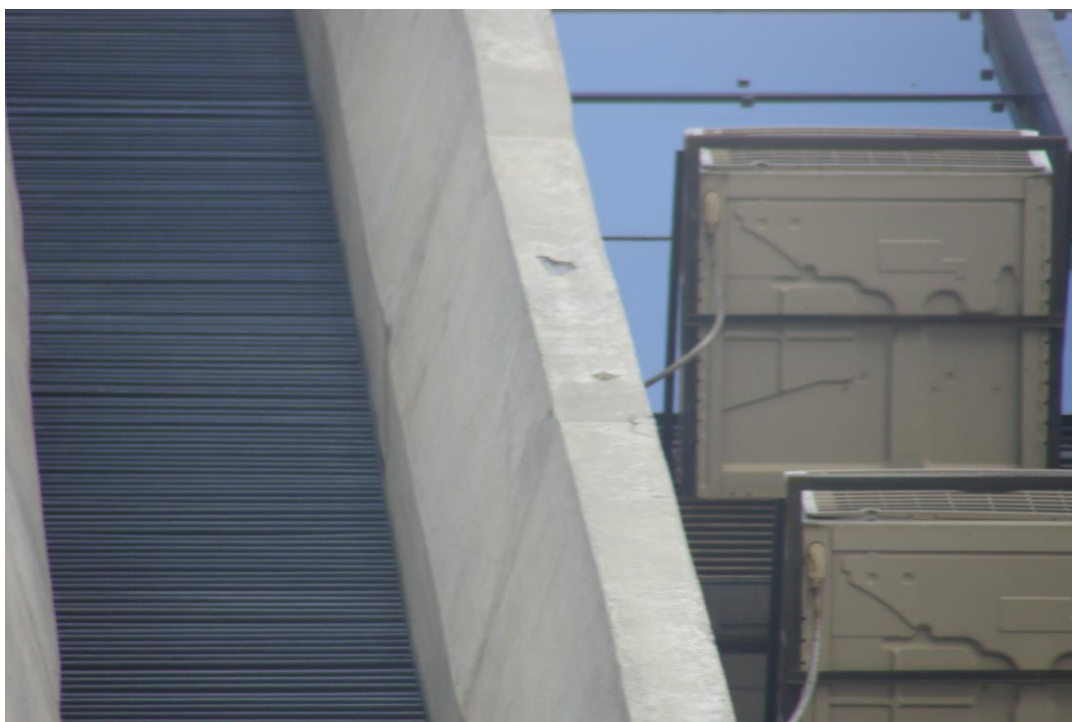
Armadura exposta pilar P13 (9º pavimento) (19/11/2013)
